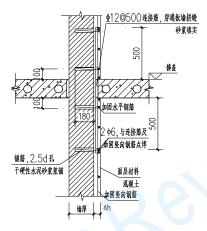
单面钢筋混凝土板墙做法 Fig. 10 Strengthened by External Reinforced Concrete Layer on one side
